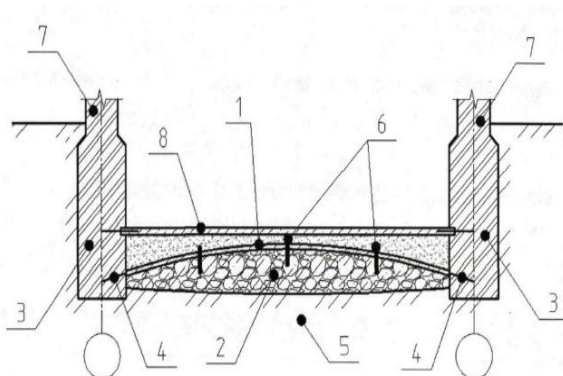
Схема перевлаштування стрічкових фундаментів в плиту перемінної жорсткості: 1 – армована оболонка підсилення; 2 – криволінійна штучна основа з нагнітанням розчину; 3 – існуючі фундаменти; 4 – глухий анкер; 5 – по-передньо напружена при-родна основа; 6 – перфоровані ін'єктори; 7 – існуючі стіни; 8 – силова підлога
